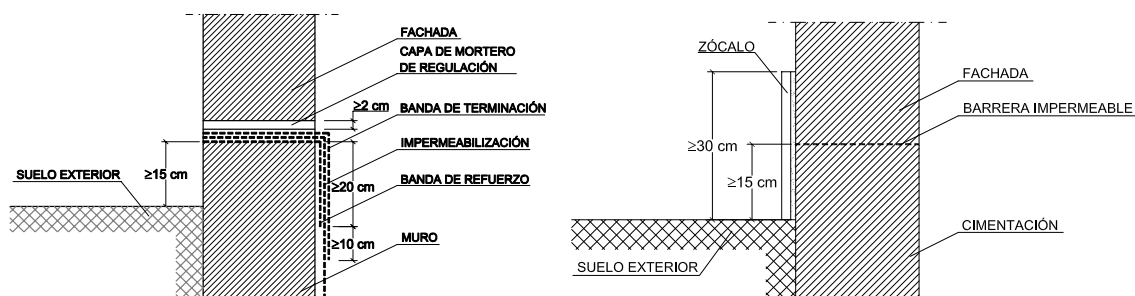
Prevención de filtración en zócalo se fachada. Propuesta del CTE
